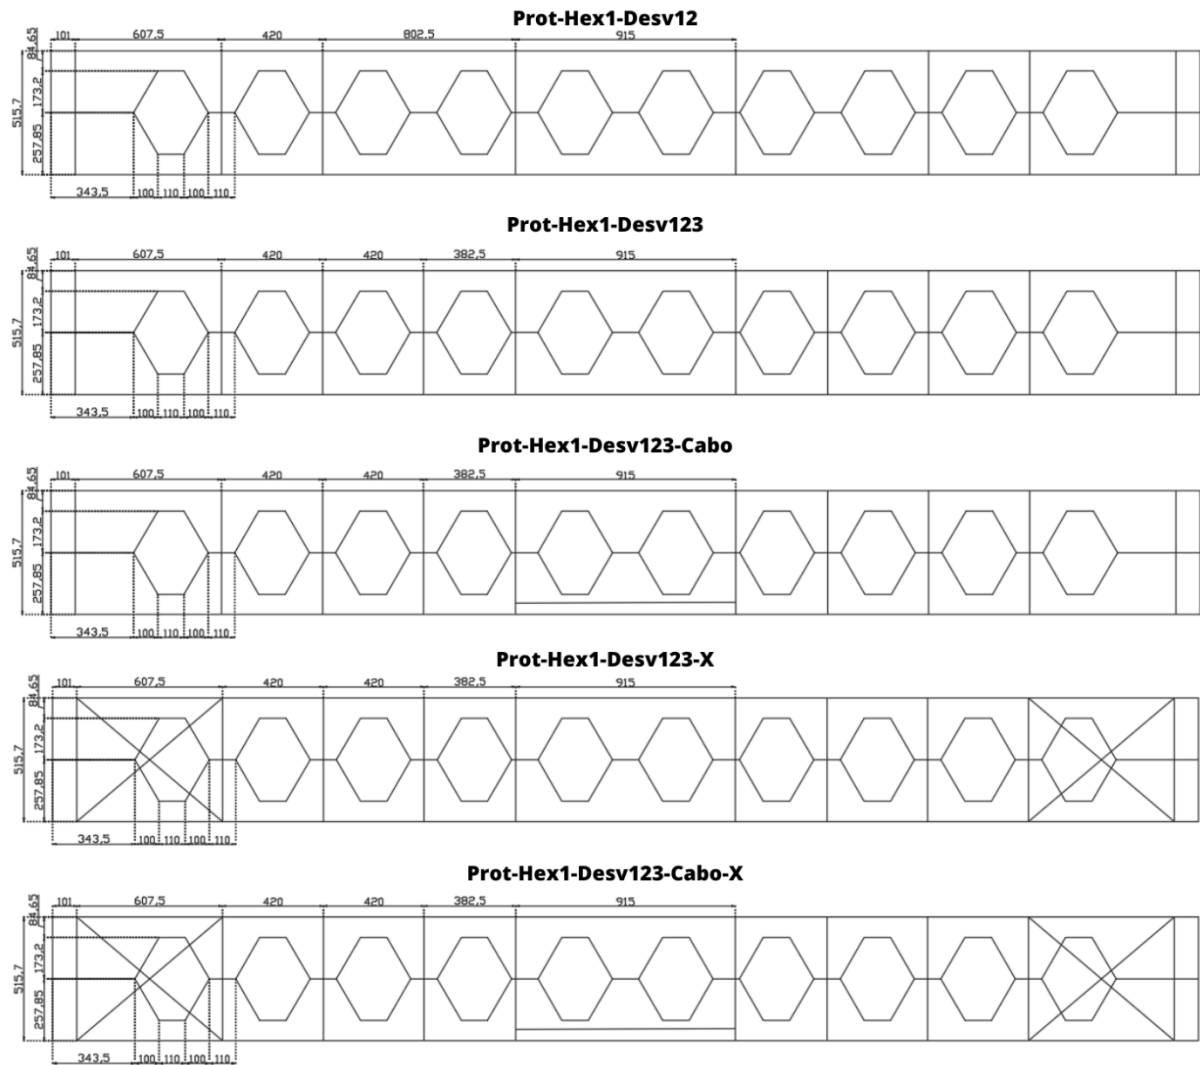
Dimensões das vigas com alvéolos hexagonais, múltiplos desviadores extras e alterações na viga.
